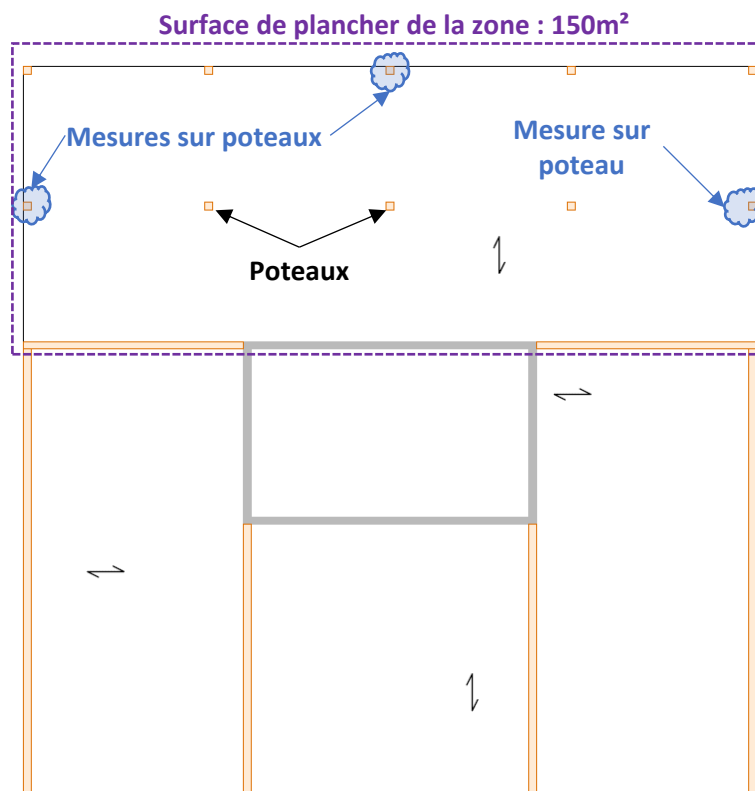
Exemple d'échantillonnage sur un plan d'étage quelconque pour le contrôle de l'humidité des poteaux (poteaux intérieurs considérés non exposés)
